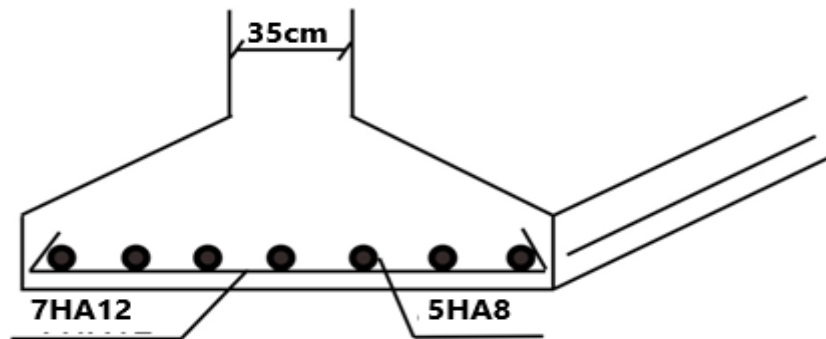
Ferrailage de la semelle filante
